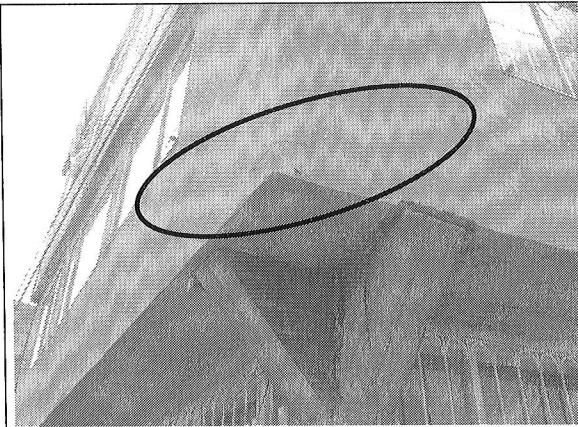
Mensula y fisuras en el muro de fachada.
